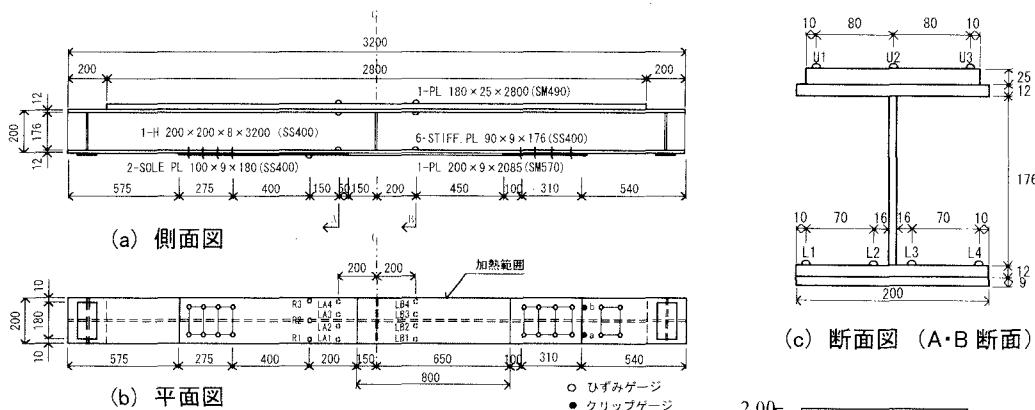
試験体の形状と寸法、およびひずみゲージ貼付位置
